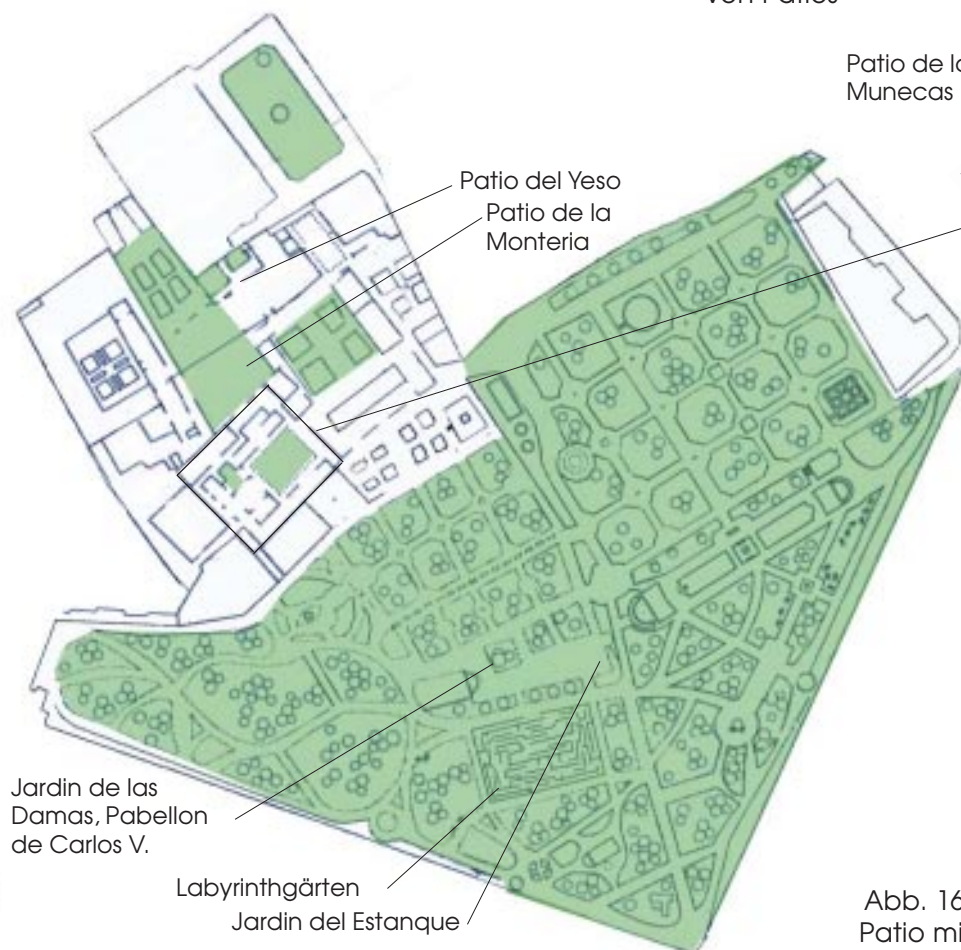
Lageplan der Palastanlage Alcazar mit den Gärten Alcazares Reales
